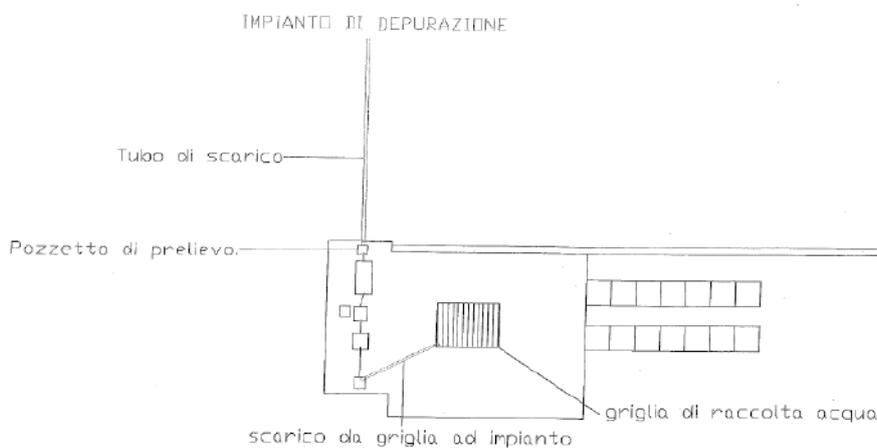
Layout in pianta dell'impianto di depurazione fisico-biologico
